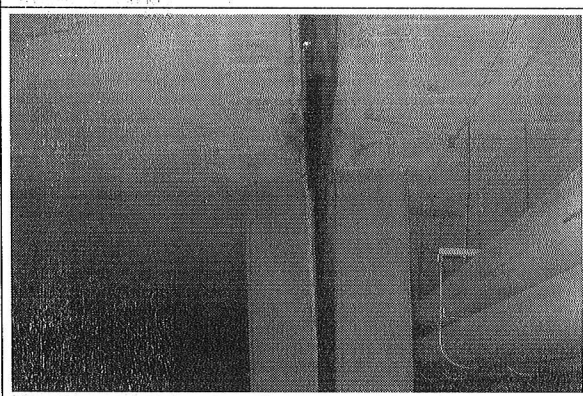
Pérdida de verticalidad en columnas de la plataforma.
